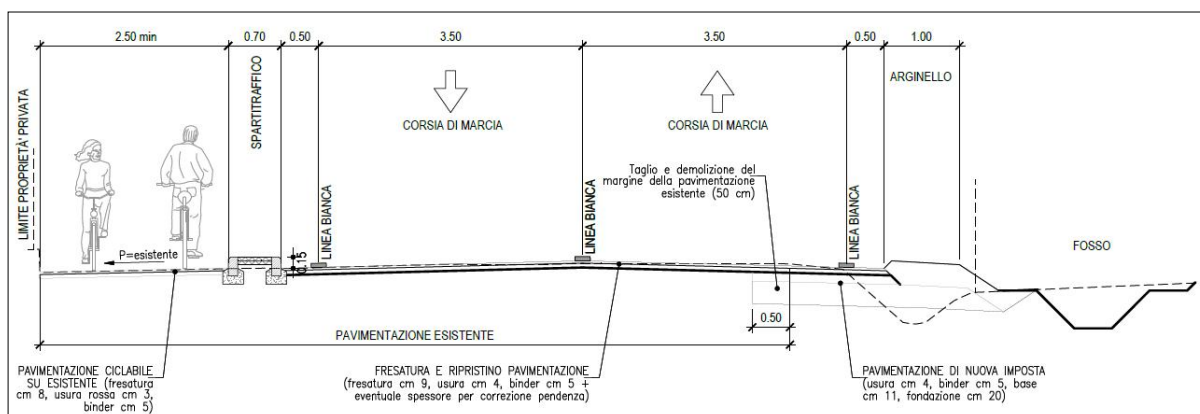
sezione tipica dell'adeguamento di via del Bargello.
